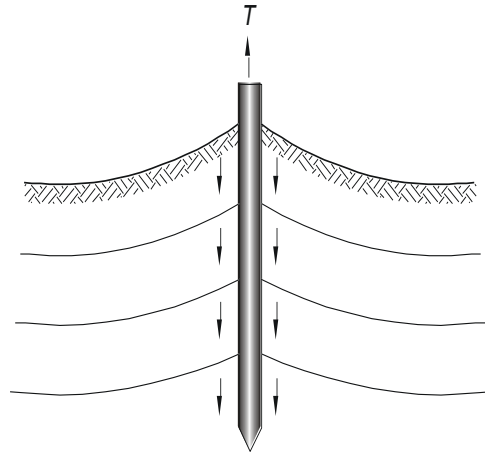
, APLICACIÓN DE PILOTES PARA CARGAS DE EXTRACCIÓN
